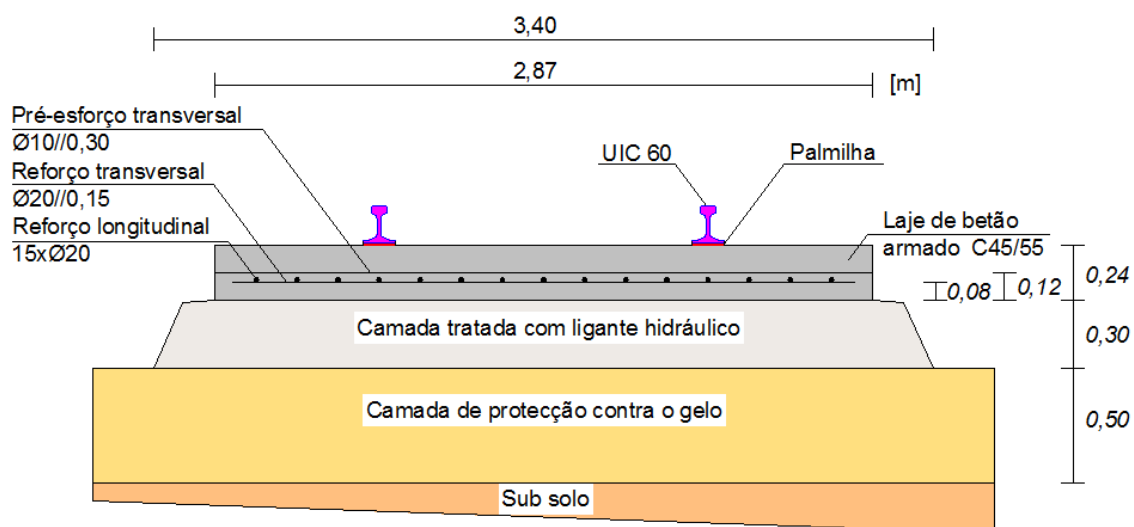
Perfil transversal esquemático da via em laje com armadura ordinária inferior e pré-esforço transversal (Marques, J. 2013)
